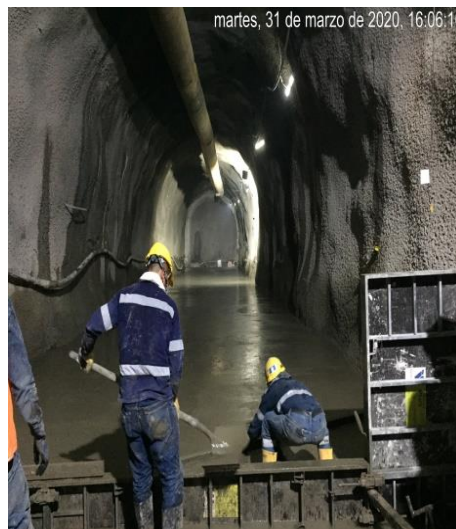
hormigonado de solera (Autor: Fuente Propia)
